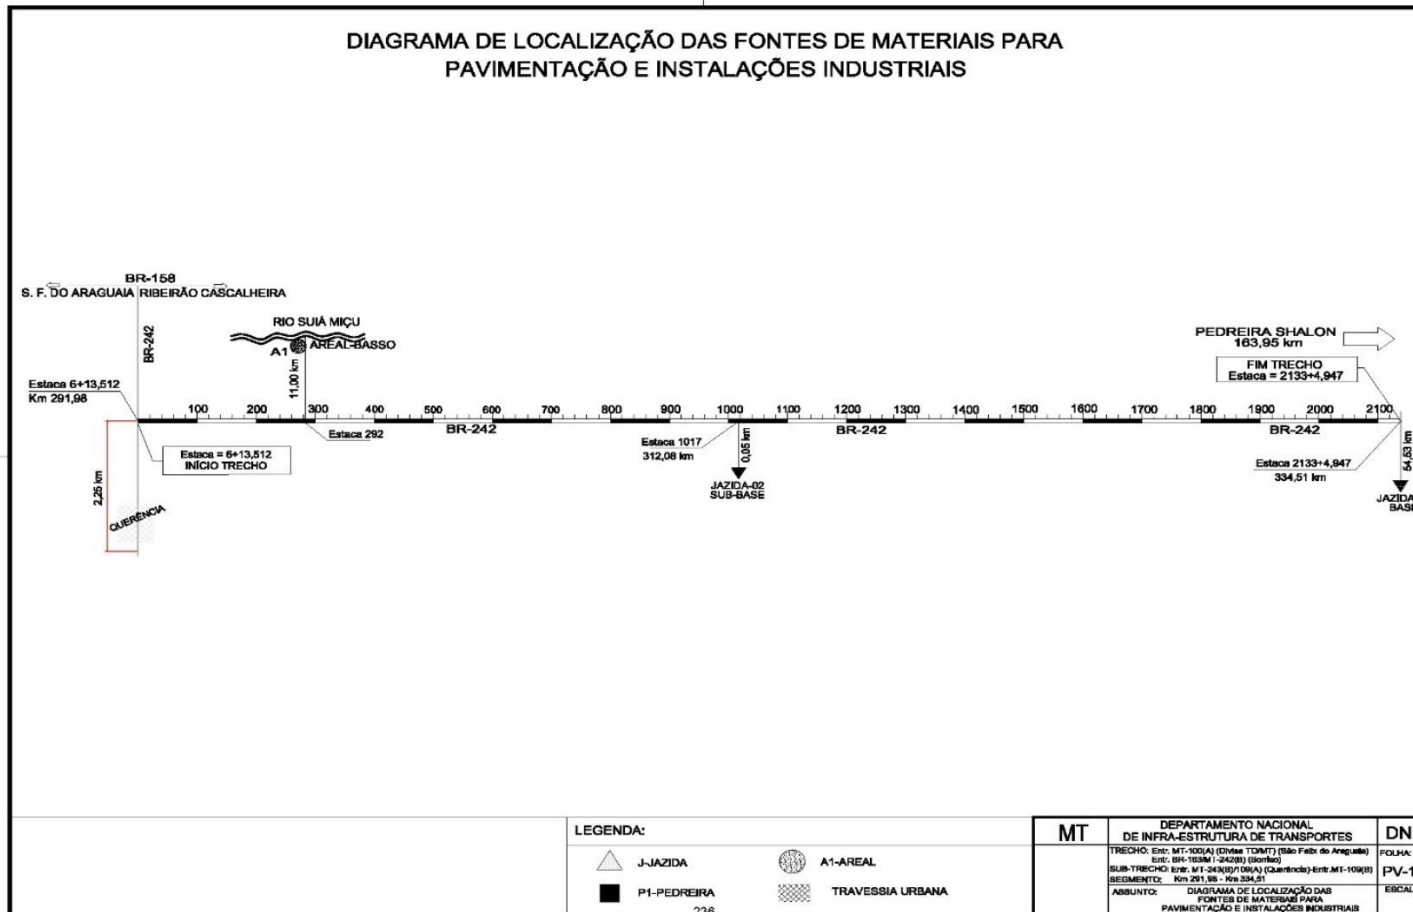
Diagrama da localização das fontes de materiais para a pavimentação e as instalações industriais (Segmento C – lote 11).
